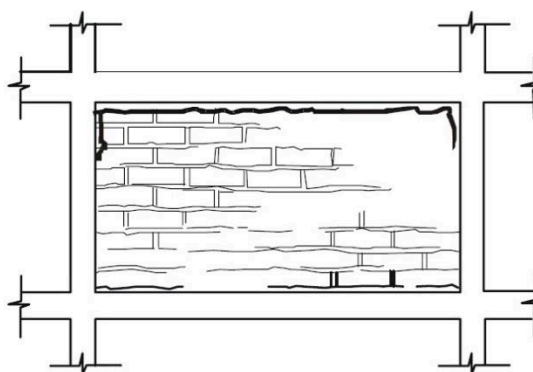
Fissuras de destacamento dentre a parede e a estrutura reticulada de concreto armado por retração da alvenaria (THOMAZ, 1989).
